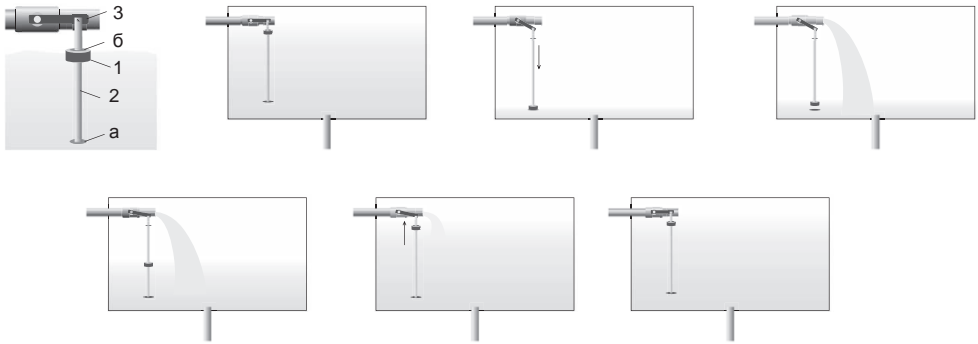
Работа поплавочно-рычажного механизма: 1 — поплавок; 2 — стержень; 3 — рычаг вентиля; а — нижний стопор; б — верхний стопор
